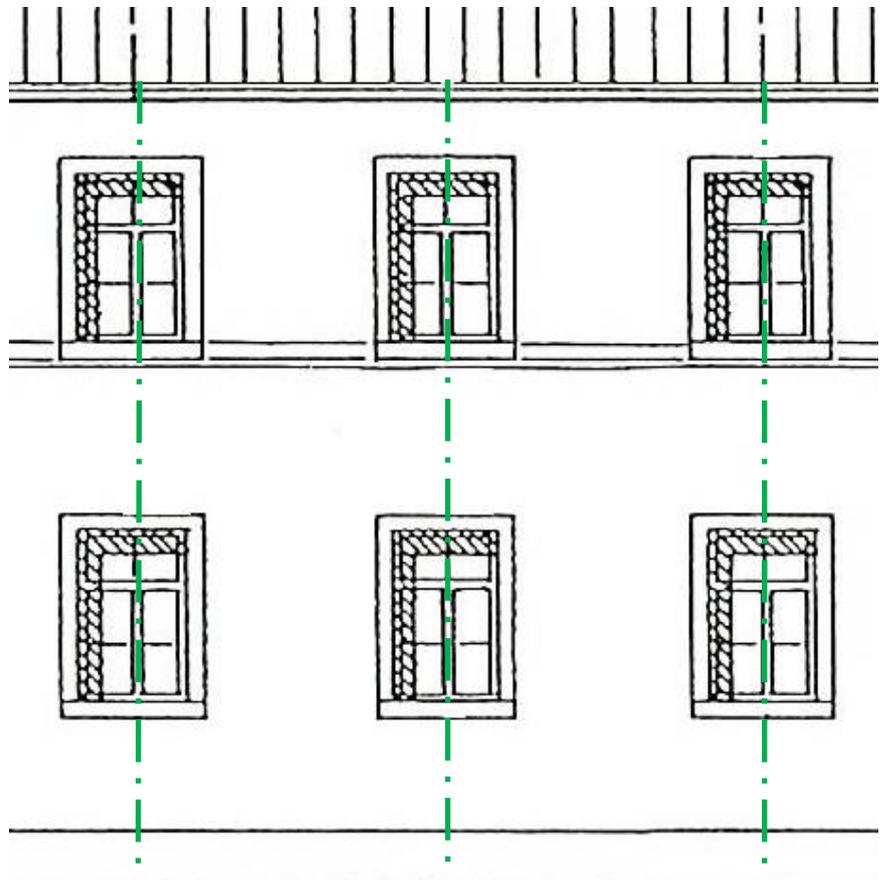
Klare Fassadengliederung, Fensteröffnungen werden axial angeordnet
